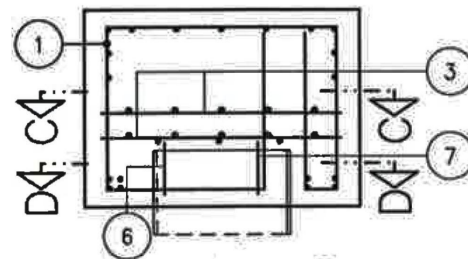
Bewehrungsanordnung Schnitt A-A für Vertikal- und Horizontallasten [6]
